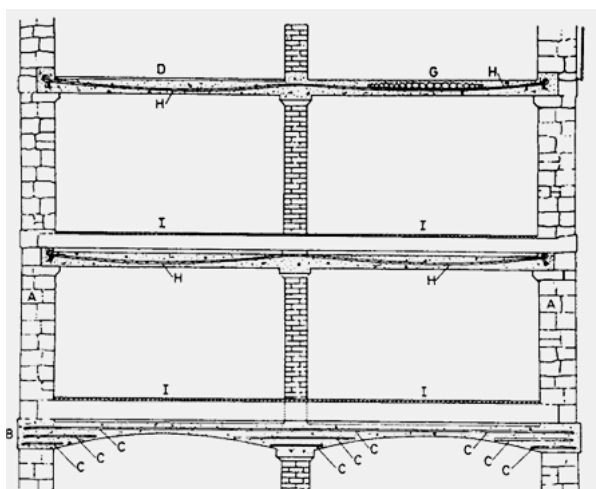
Esquema do sistema construtivo desenvolvido por William Wilkinson, adaptado de (Barbisan e Gardin, 2008).
